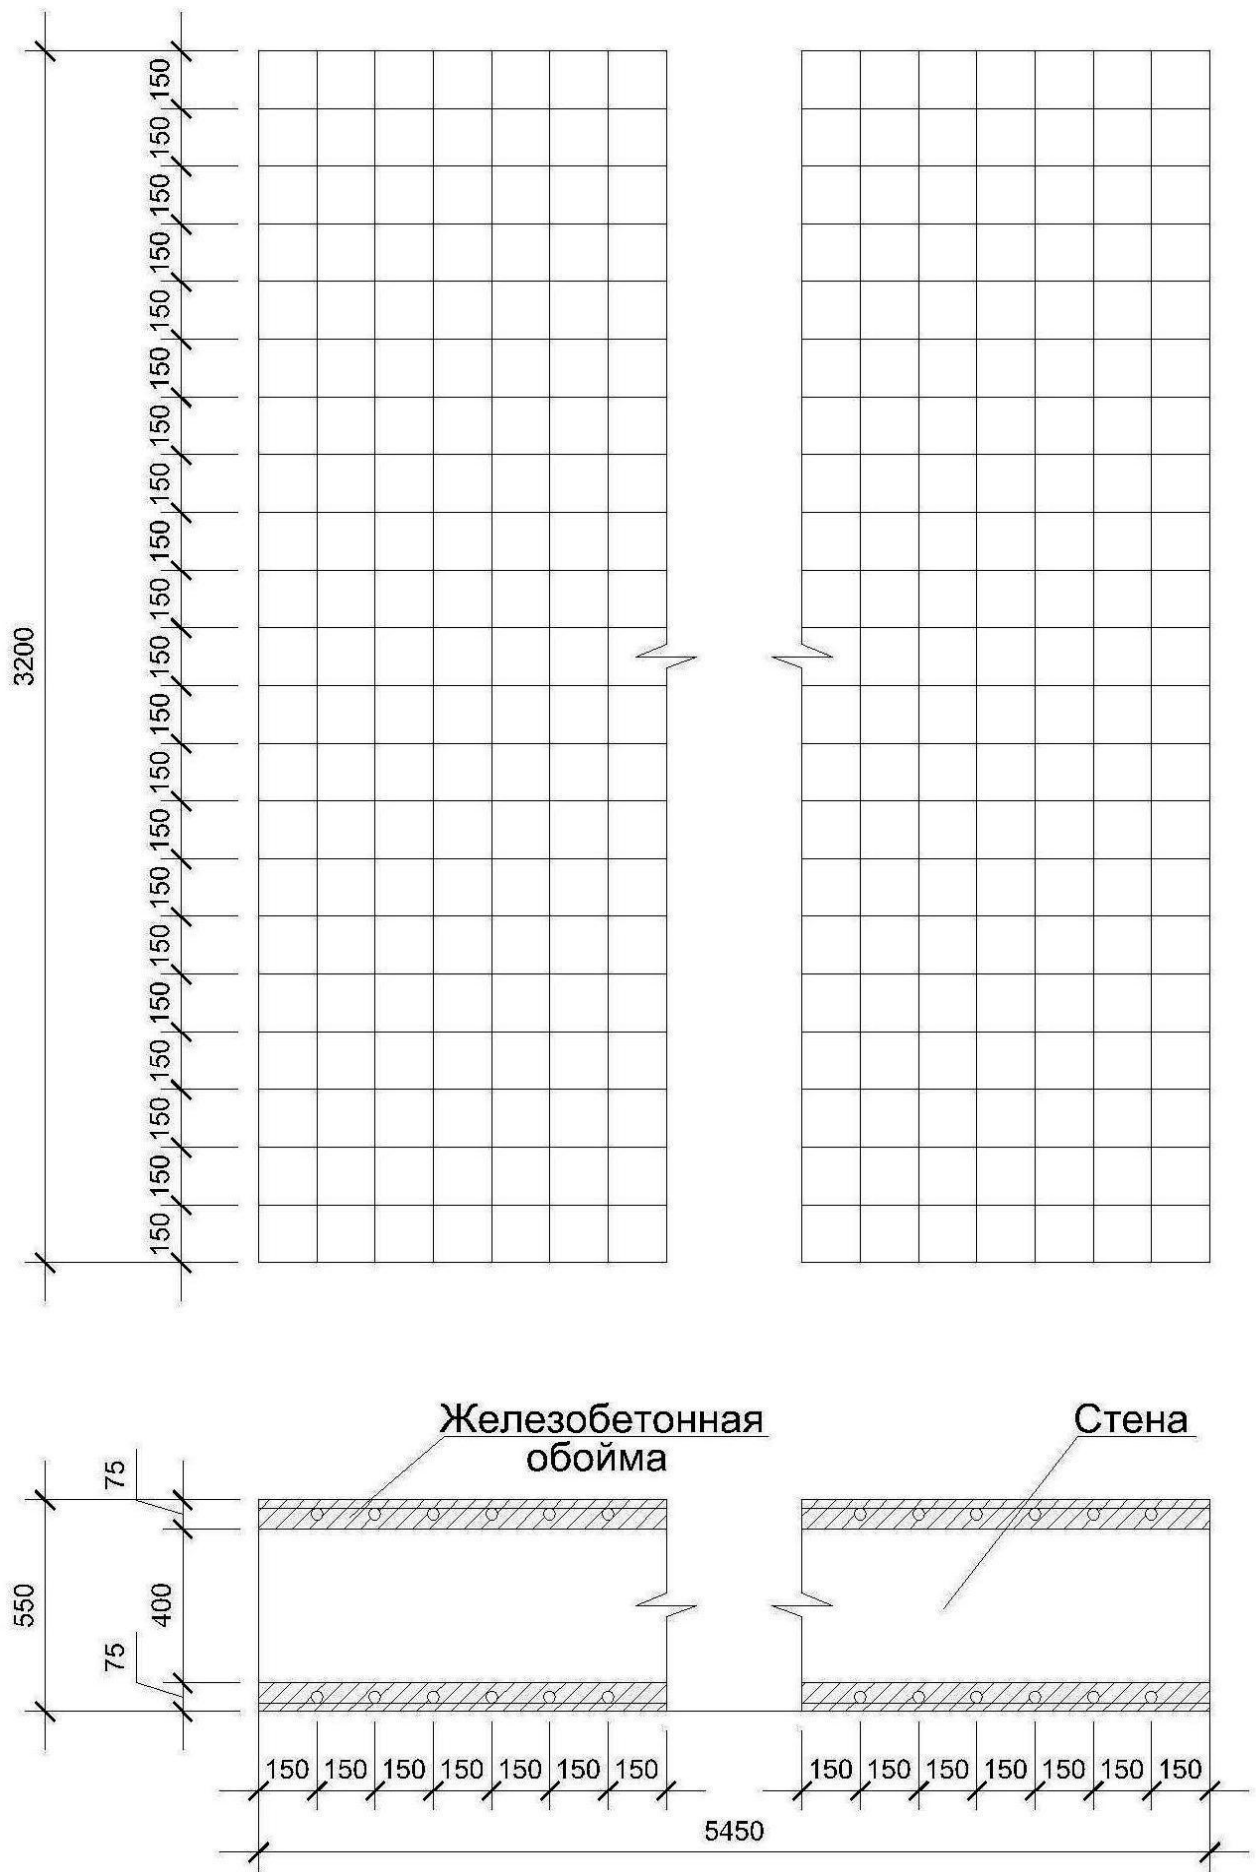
Усиление стены подвала железобетонной обоймой
